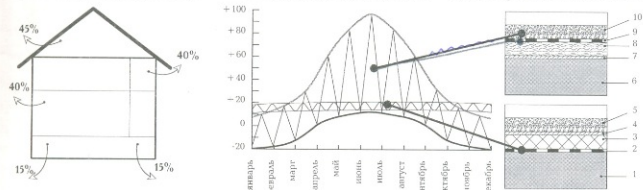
, 2. 1, 6 — перекрытие, 2, 9 — гидроизоляция, 3 — утеплитель Roofmate™, 4 — ковровый слой для защиты от осмы, 5, 10 — функциональный слой, 7 — пароизоляция, 8 — минеральная вата
